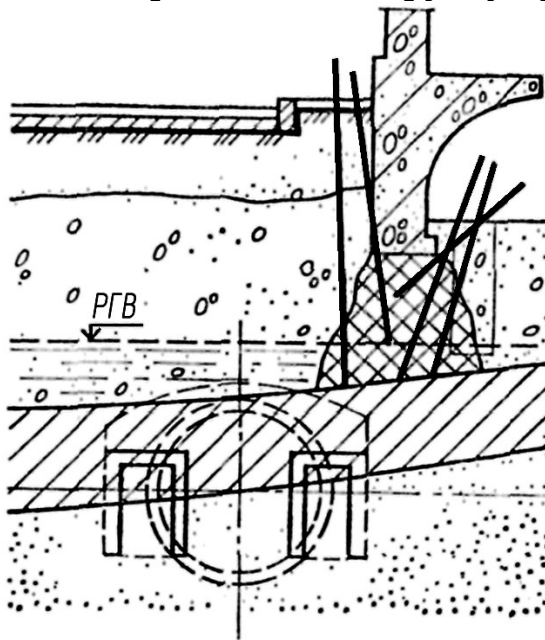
Закріплення ґрунту під фундаментом будівлі на вул. Моховій
